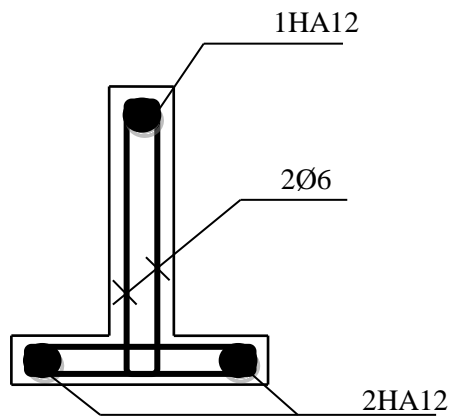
Ferrailage de la Poutrelle de terrasse type 2 en travée.
